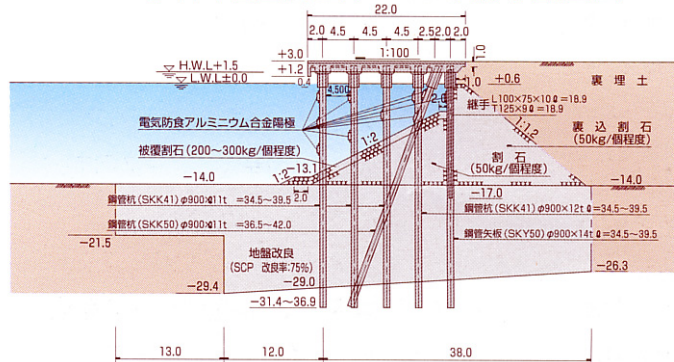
野々田地区-13m 岸壁の標準断面図（資料 1）
